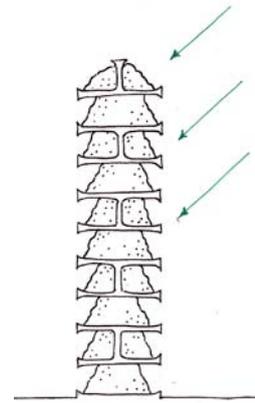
Lavado de las piezas en un muro de adobe recibido con mortero de cal.
